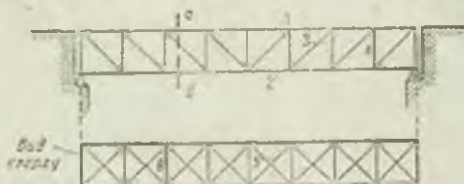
Схема пролетного строения железнодорожного моста со сквозными (решетчатыми) фермами для езды поверху:
